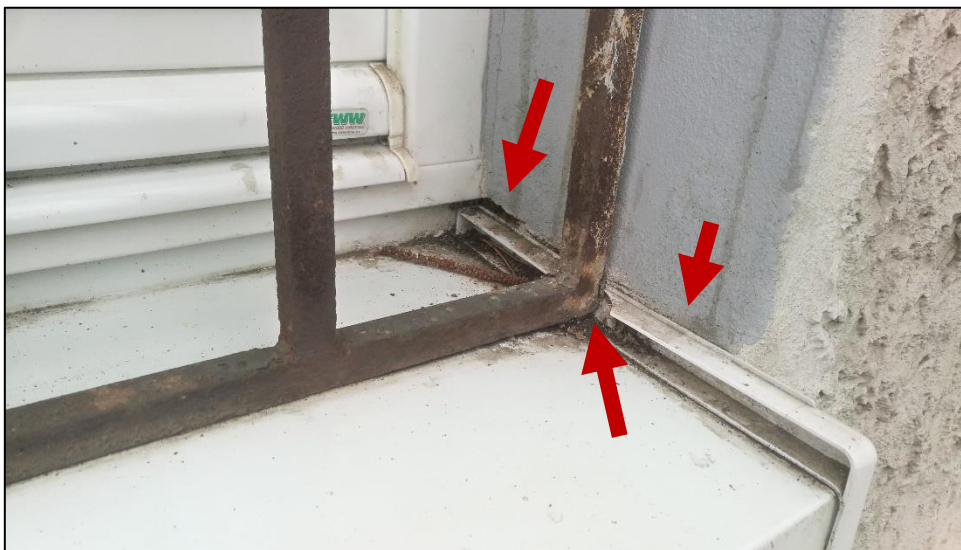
Dtto Foto č. 41, mechanické poškození bočních plastových krytek oplechování.
